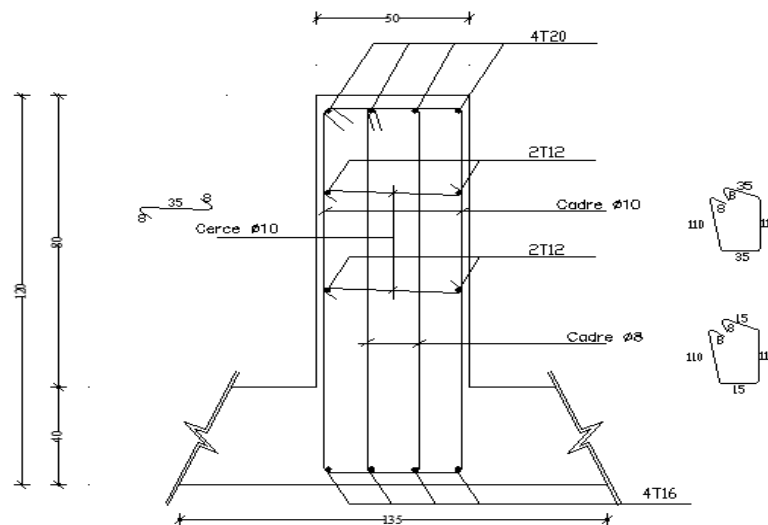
Dessin ferrailage des poutres principales de radier
